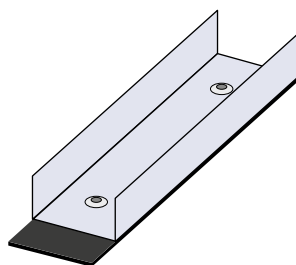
Aplicação de banda acústica entre o perfil raia e o suporte.
